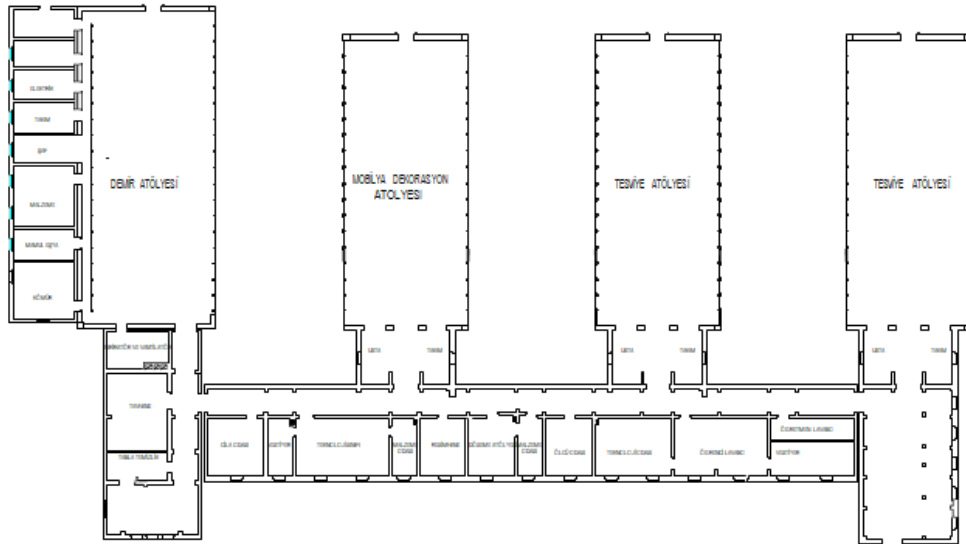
1974 Yılına Ait Vaziyet Planı
